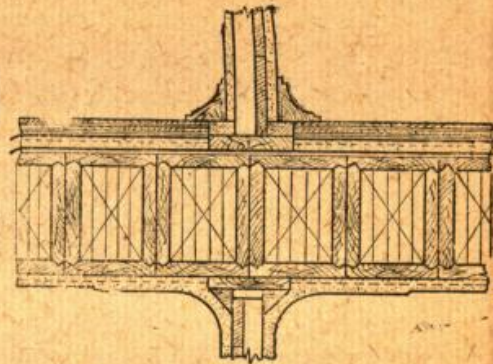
Примыкание перекрытия к перегородкам. Направление перегородок совпадает с направлением настила.
